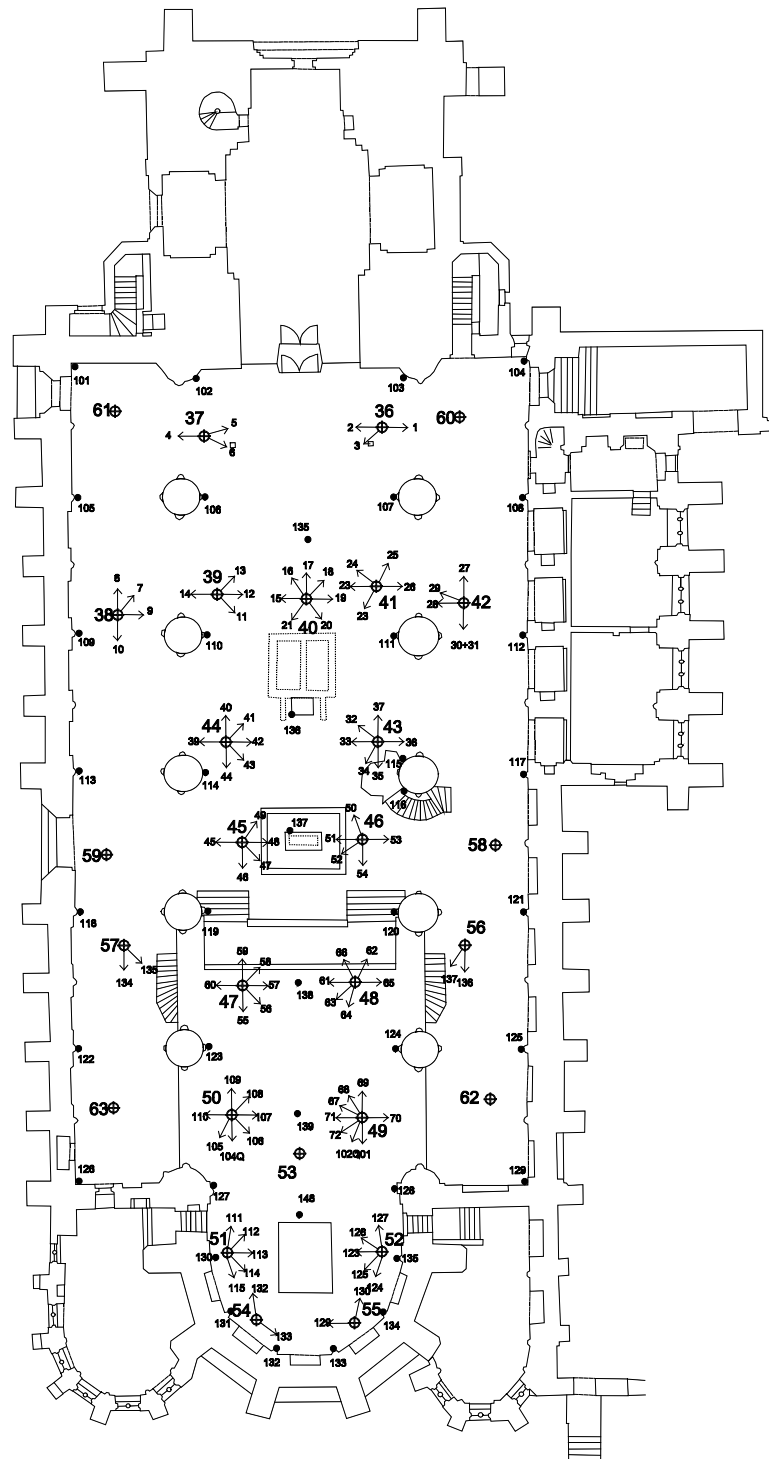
Grundriß mit Standpunkten und Aufnahmerichtungen
